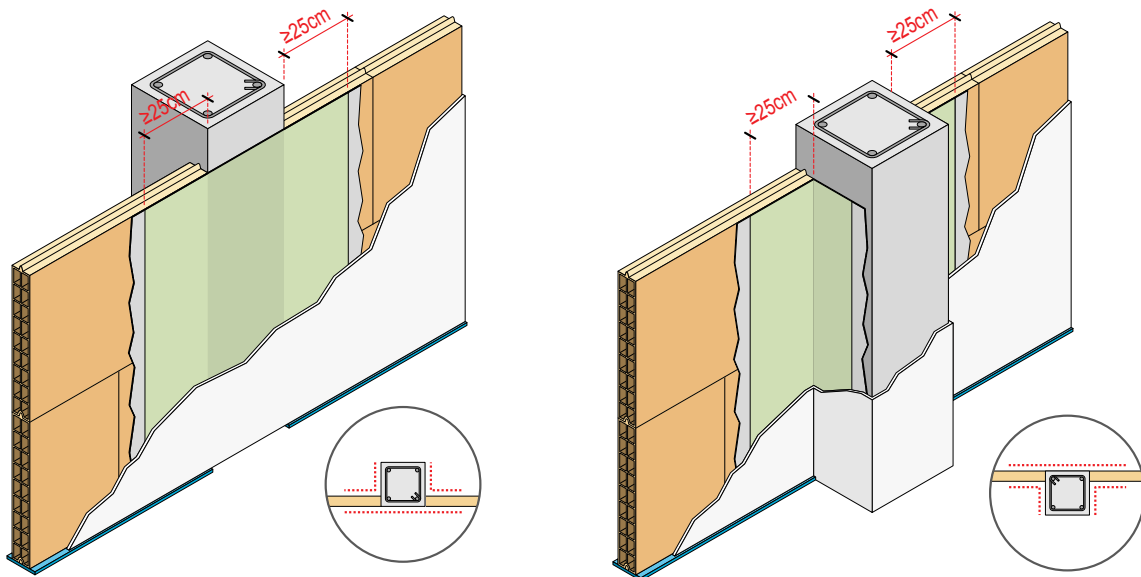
Encuentro de un tabique con un pilar sin cajado. Colocación de las bandas de refuerzo.
